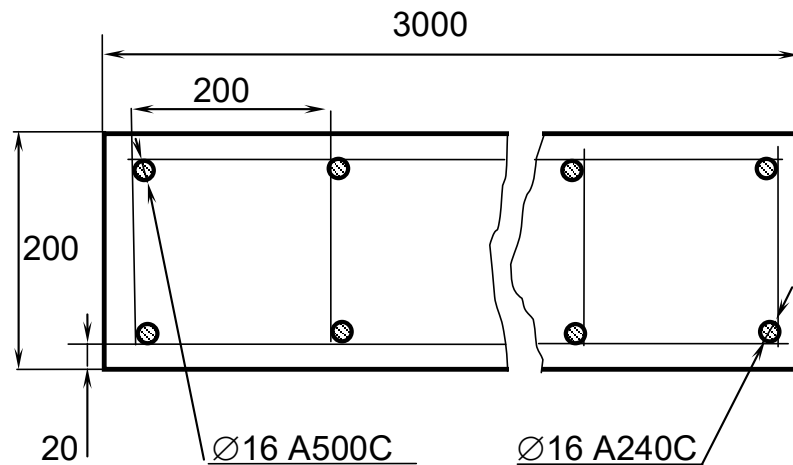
Геометричні параметри та схема армування перерізу фрагменту залізобетонної стіни-зразку для випробувань
